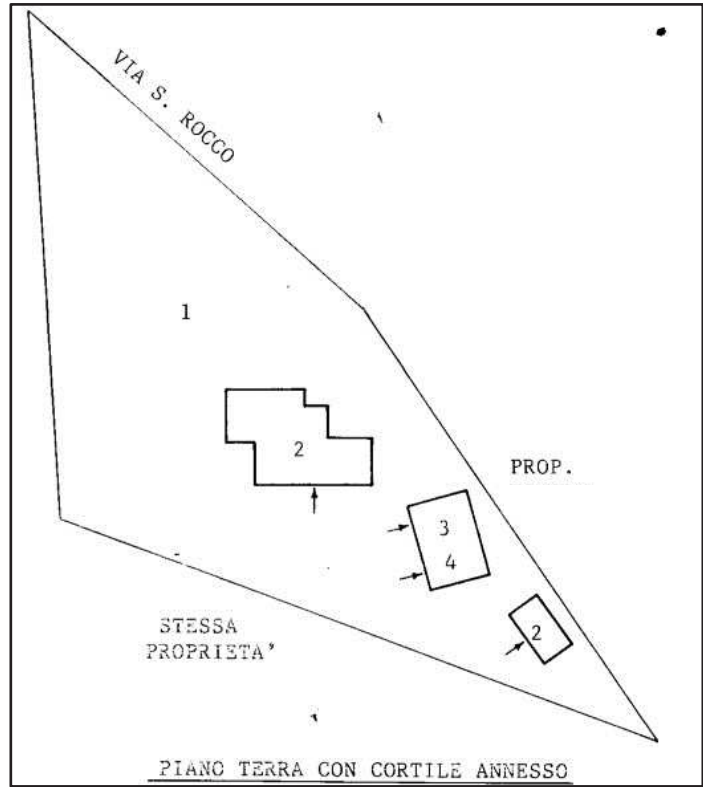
Estratto dell'elaborato planimetrico del 05.07.1991
